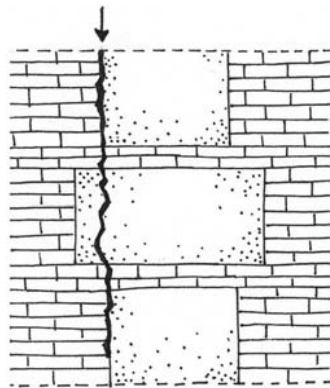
Mecanismo de degradación por grieta estructural en un muro de tapia con machones y verdugadas de ladrillo.
